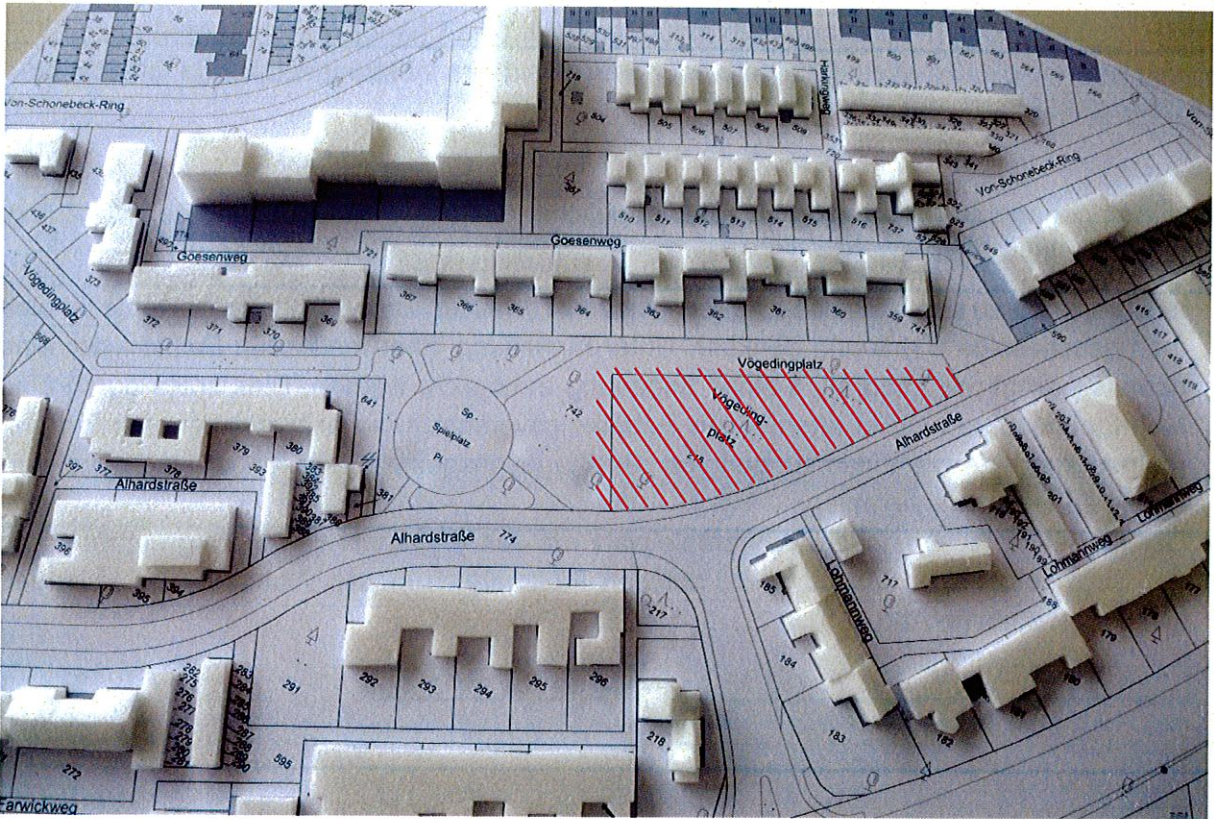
Modellabbildung I. Im rot schraffierten Bereich ist eine mehrgeschossige Bebauung grundsätzlich vertretbar.
